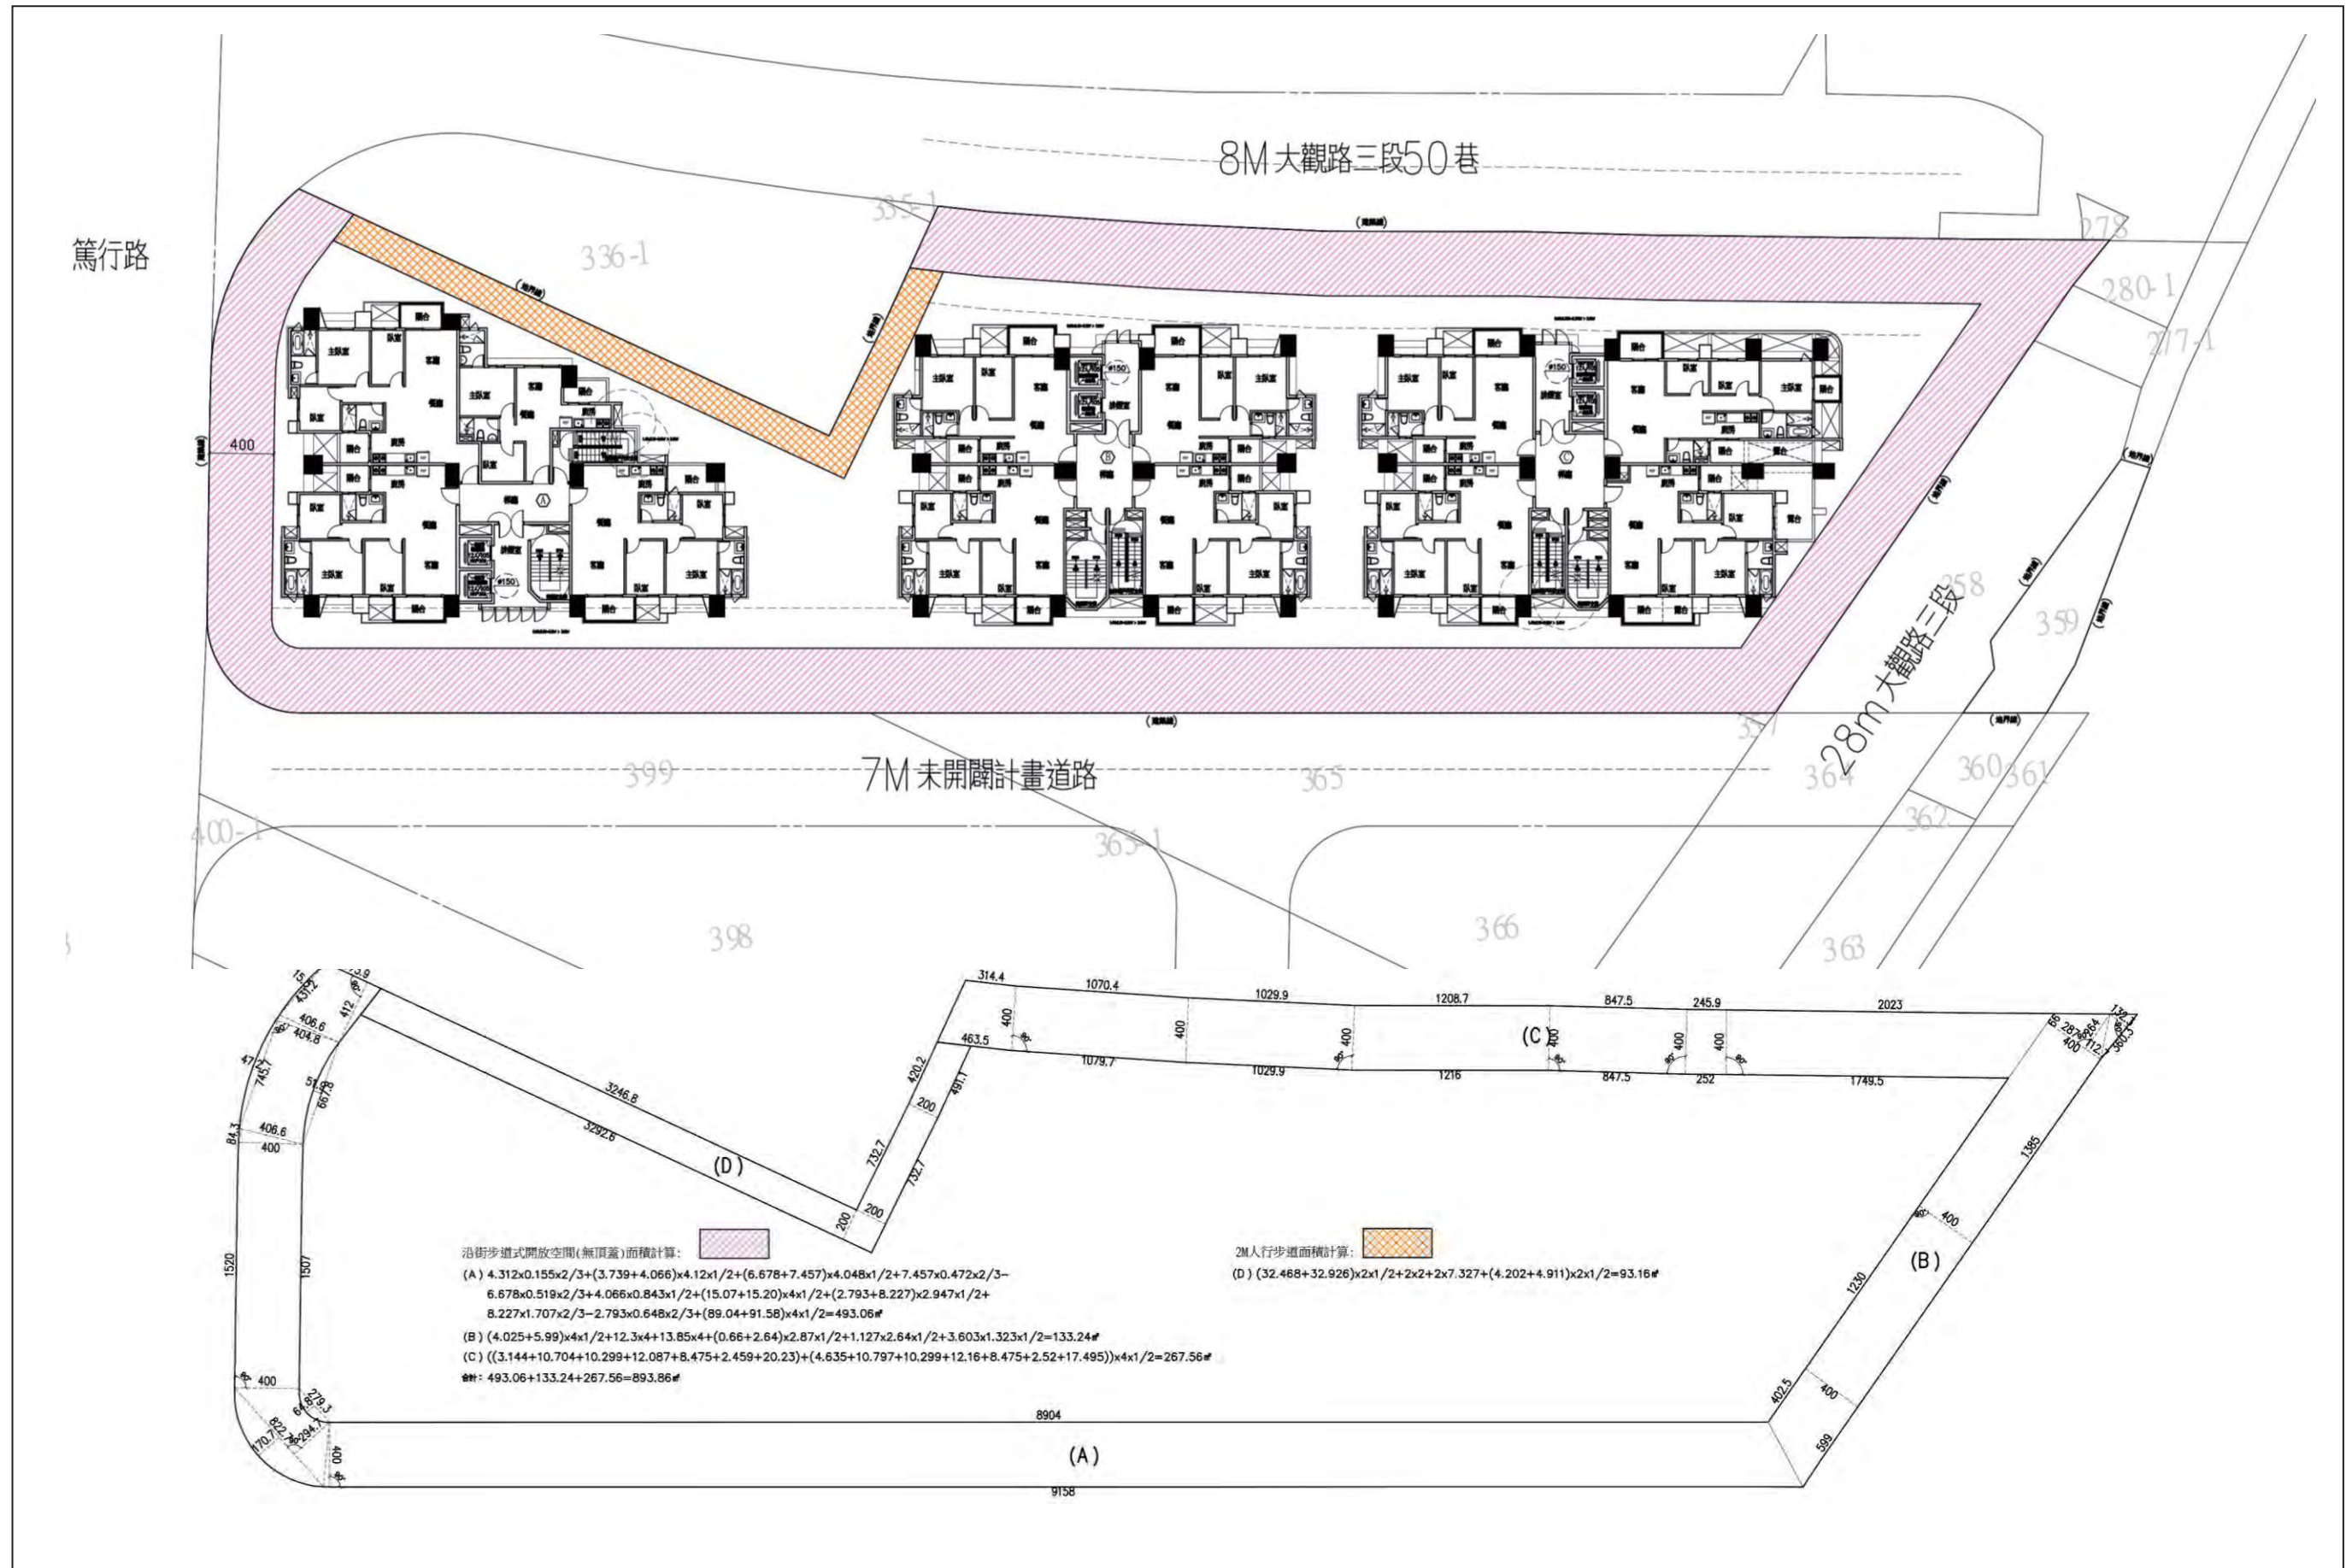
開放空間套繪標準層平面示意圖(S : 1/400)
